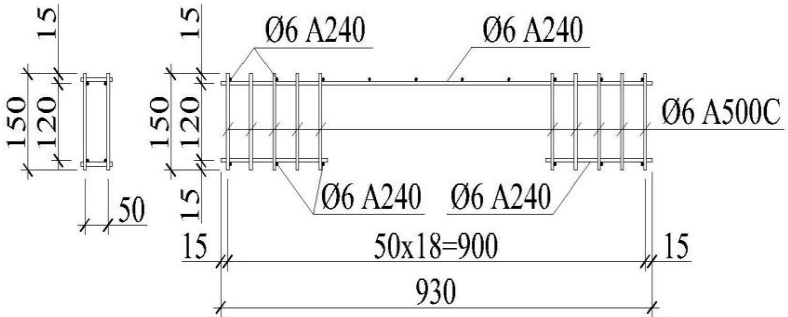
Общий вид каркасов дополнительного армирования плиты перекрытия в зонах продавливания
